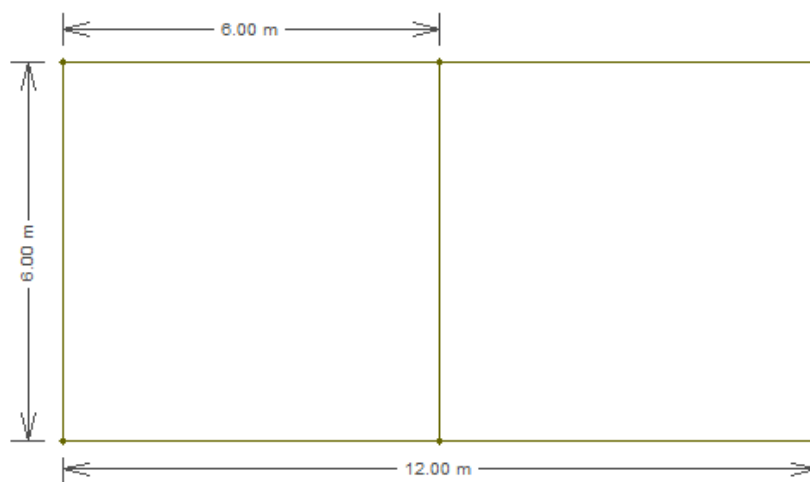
Planta da estrutura selecionada para o pórtico-tipo dois.
